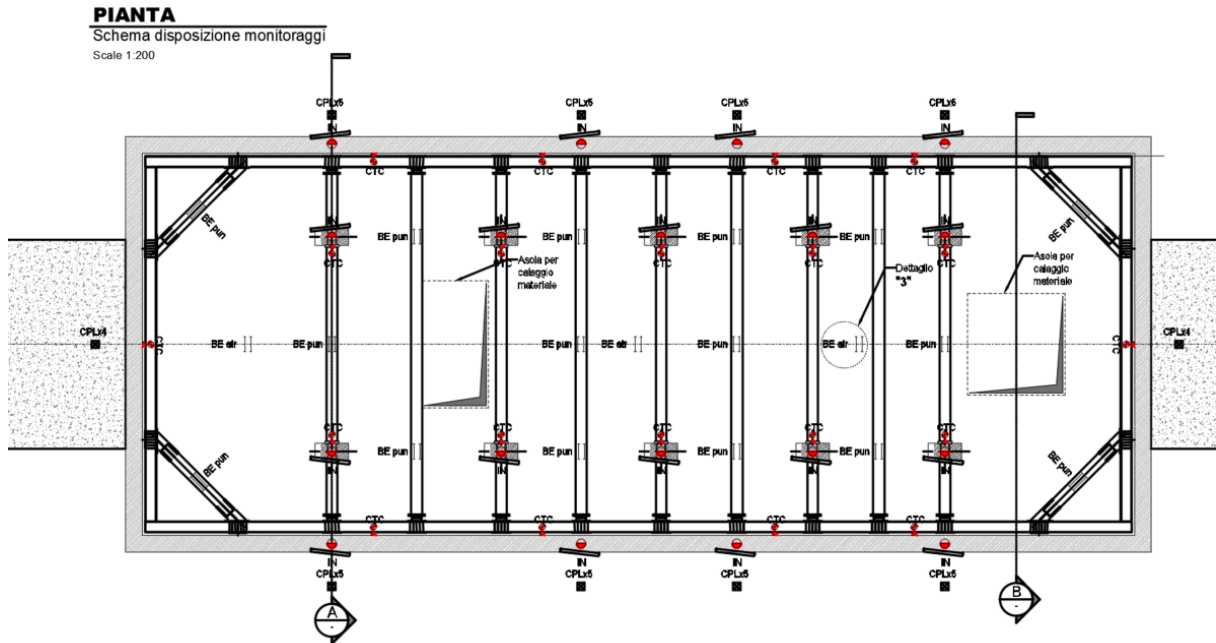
Schema preliminare di monitoraggio – Planimetria tipo
